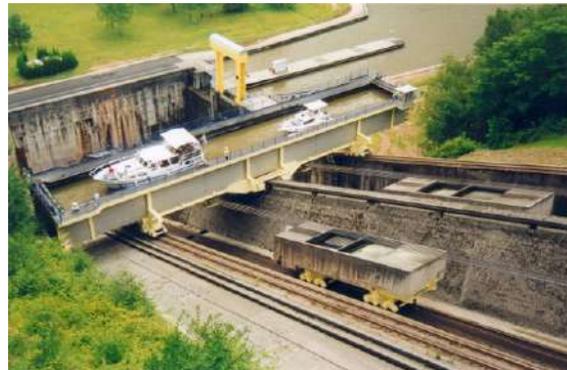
Plan incliné de St Louis-Arzwiller (source Wikipédia)
